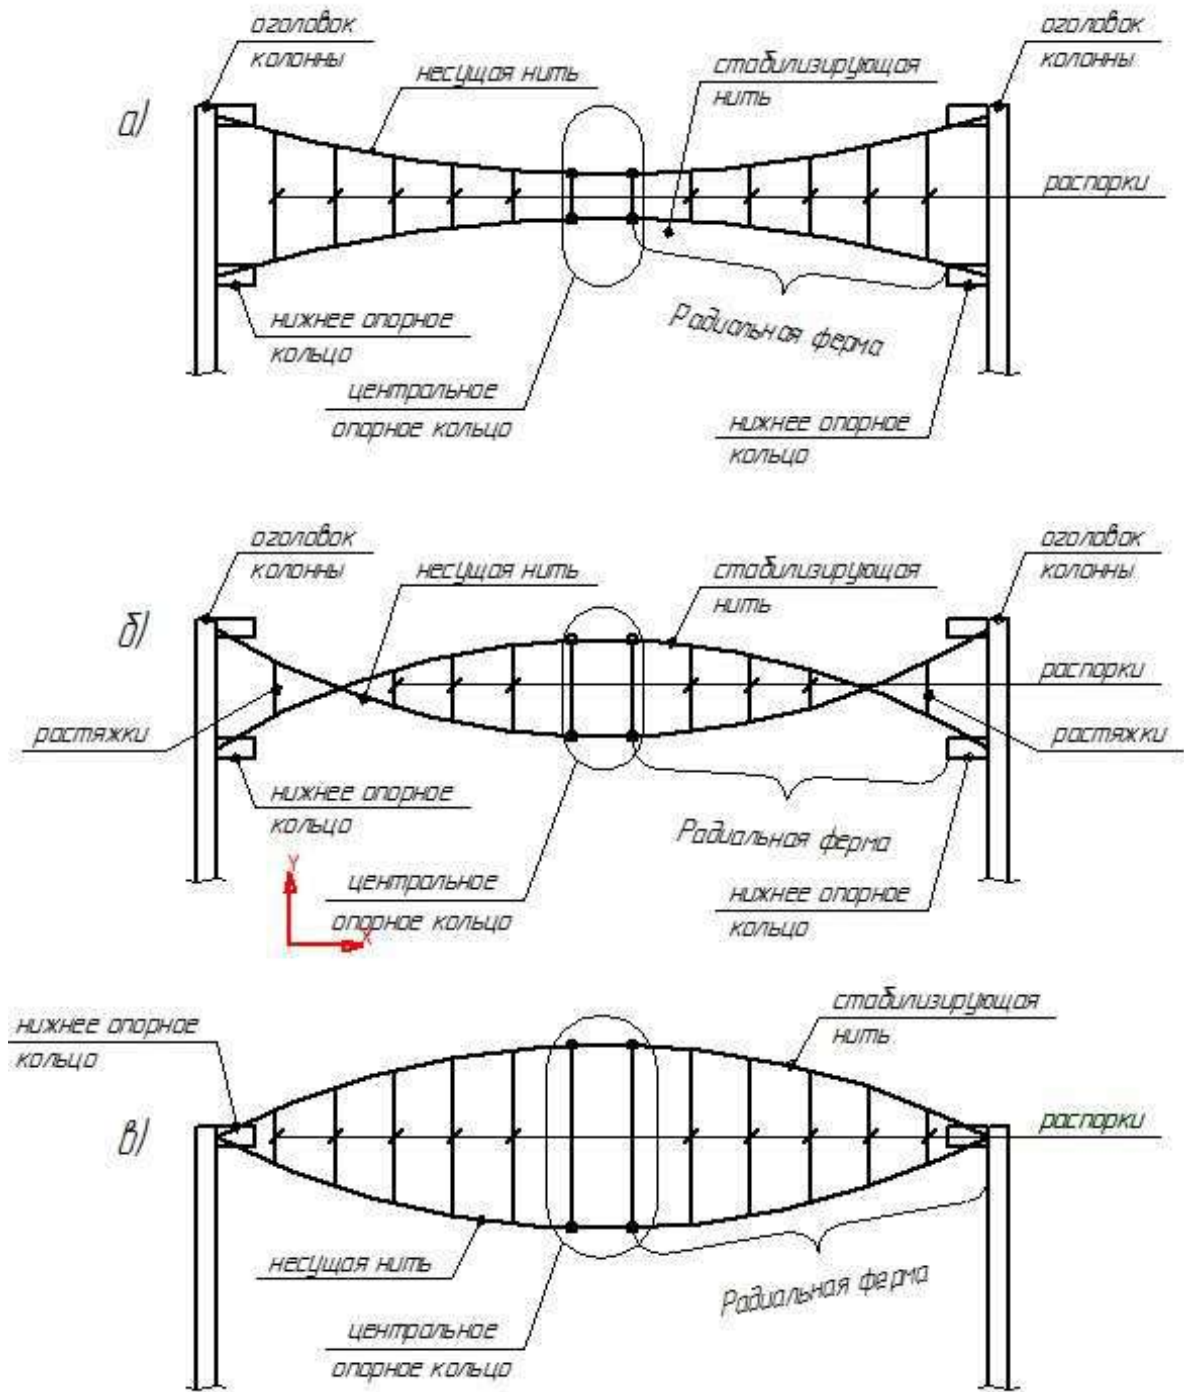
Схемы двухпоясных несущих систем в покрытиях круглого плана с центральными кольцами и с мгновенно жесткими радиальными фермами:
